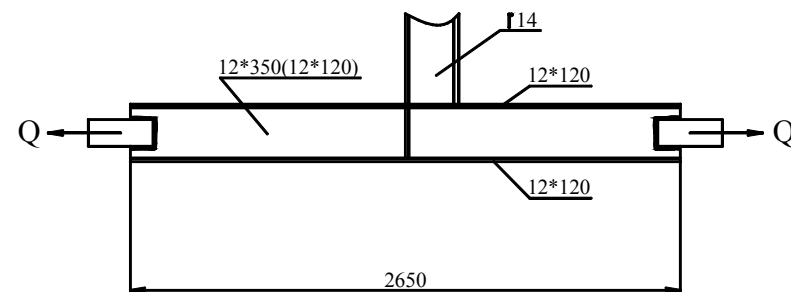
Конструкция узла пересечения тавровой бочки с поперечной связью.
